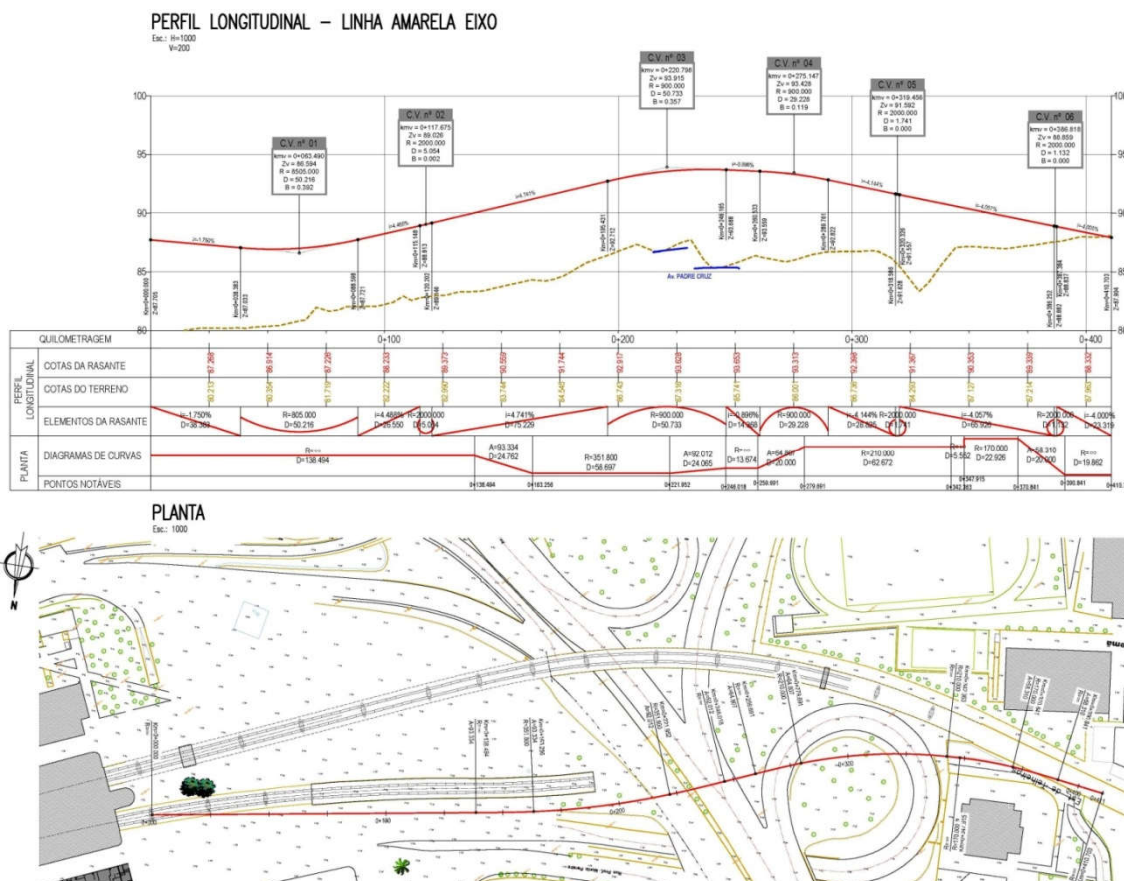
Planta e Perfil Longitudinal (eixo) do Viaduto VL2
